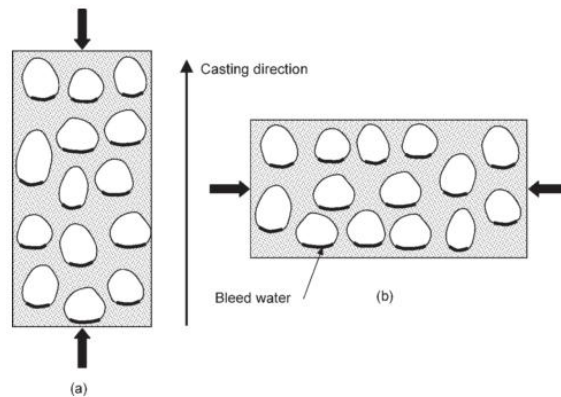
Planos de fraqueza devidos á exsudação (a) eixo vertical do testemunho (b) eixo horizontal do testemunho (BUNGEY, 1989).
